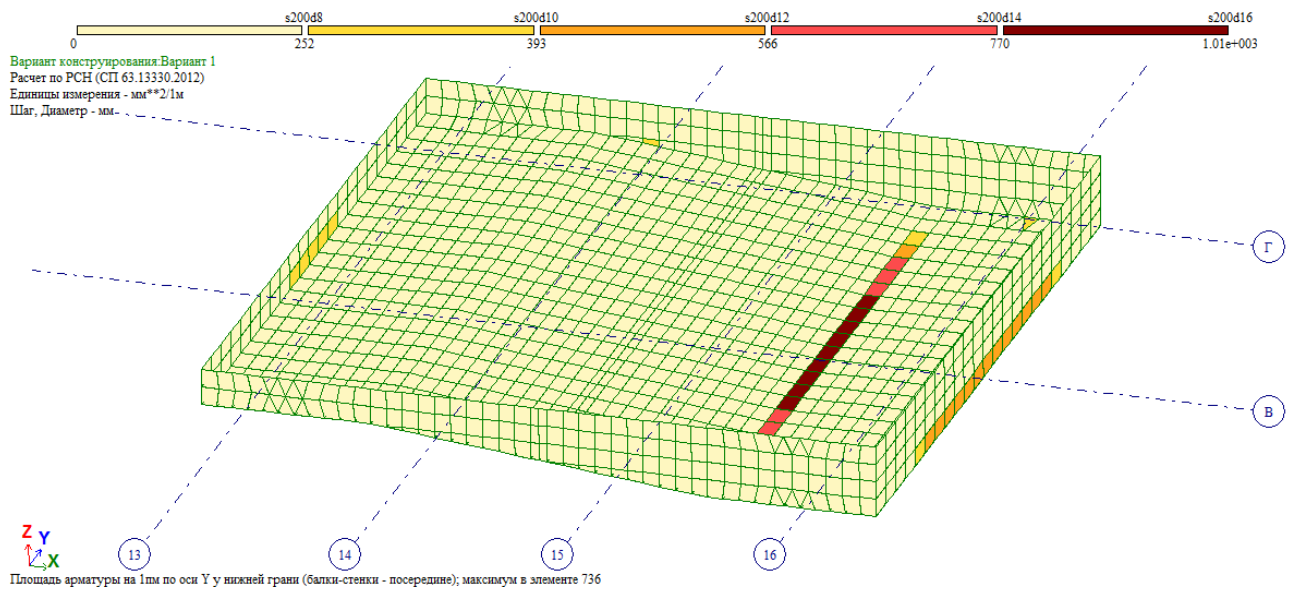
Продольная арматура нижней зоны вдоль цифровых осей
